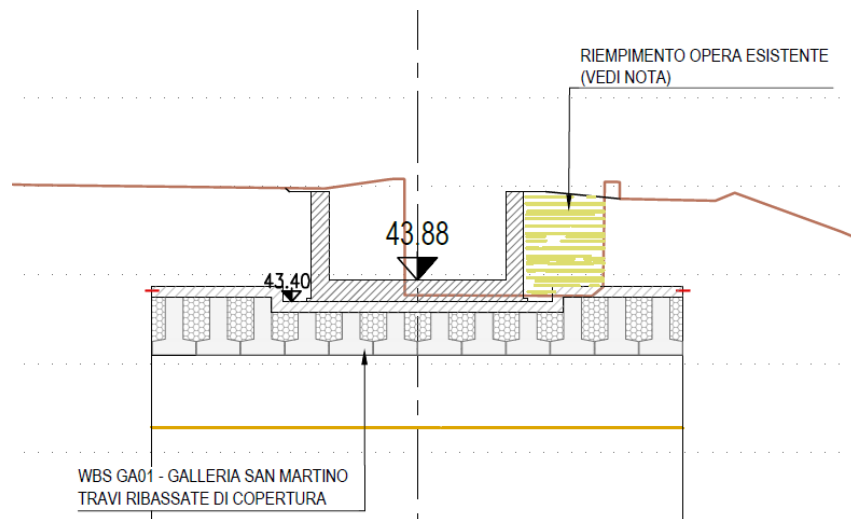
Sezione del canale a “u” di progetto in corrispondenza dell’attraversamento sopra la GA01
